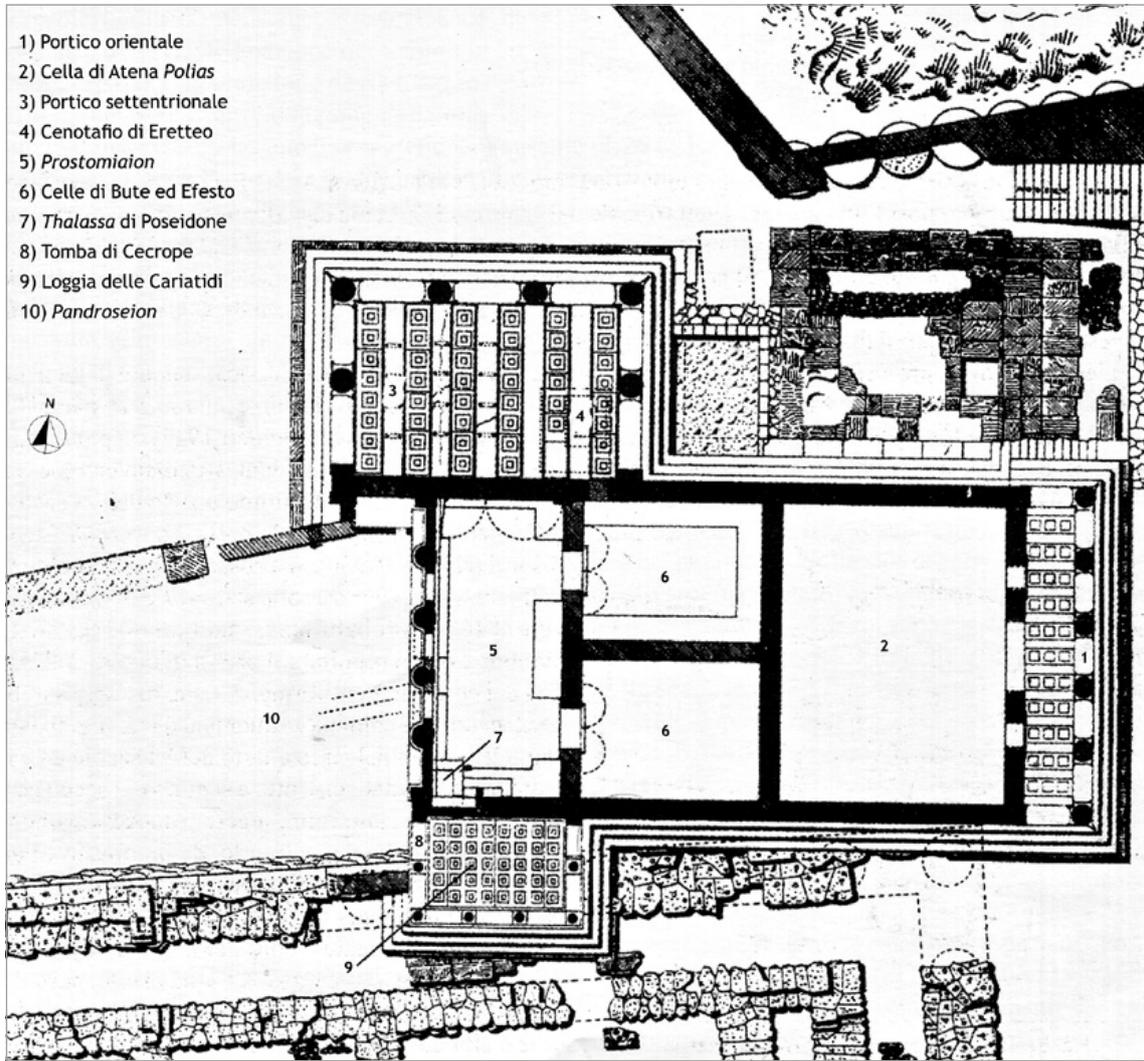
Pianta dell'Eretteo (da GRECO 2010).
